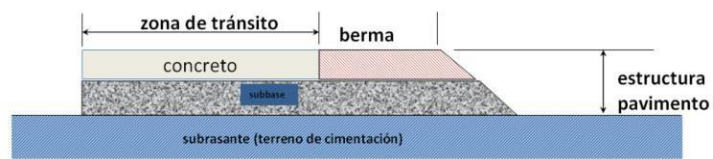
Pavimento Rígido. Fuente: M. Becerra Salas, Tópicos de Pavimentos de Concreto, Lima-Perú: Flujo libre, 2012
